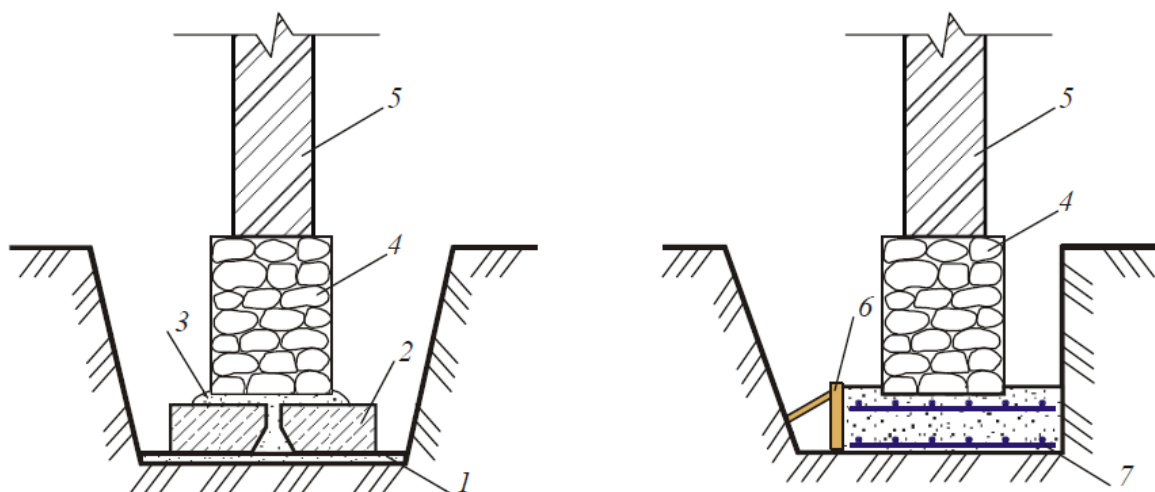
Уширение подошвы фундамента: а-подводкой железобетонных плит; б-устройством монолитной железобетонной подушки; 1-уплотненная грунтовая подготовка; 2-железобетонные плиты; 3-цементно-песчаный раствор; 4-фундамент; 5-стена; 6-опалубка; 7-арматурная сетка
